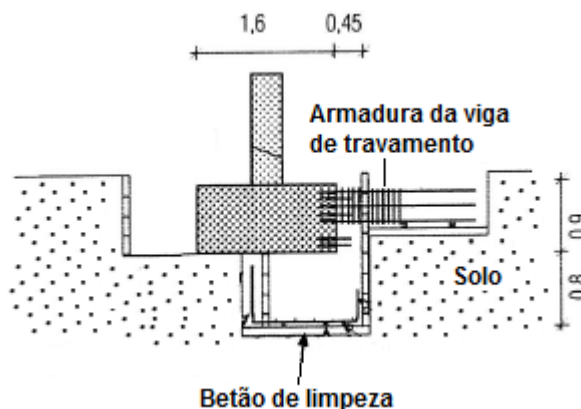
Execução da armadura do recalce e da viga de travamento [adaptado de 86]
